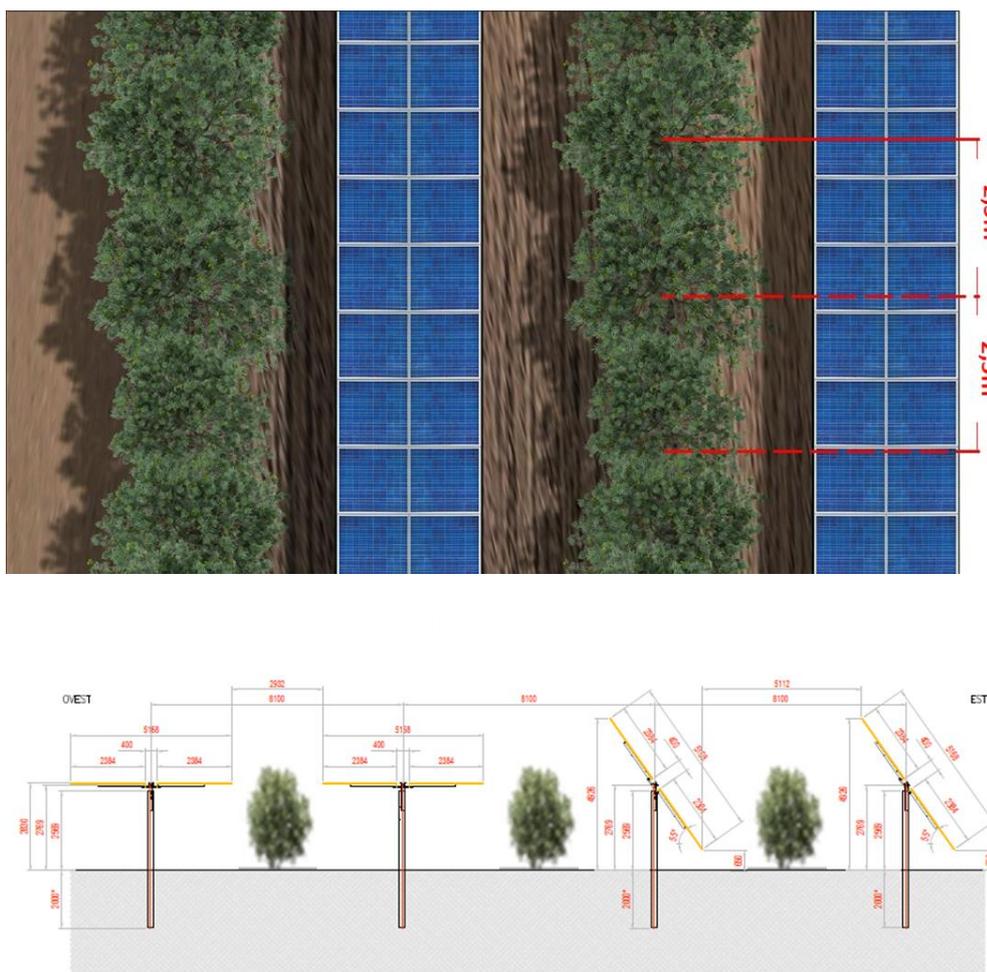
Tipologico – Vista Planimetrica e sezione dell'impianto Olivicolo.
